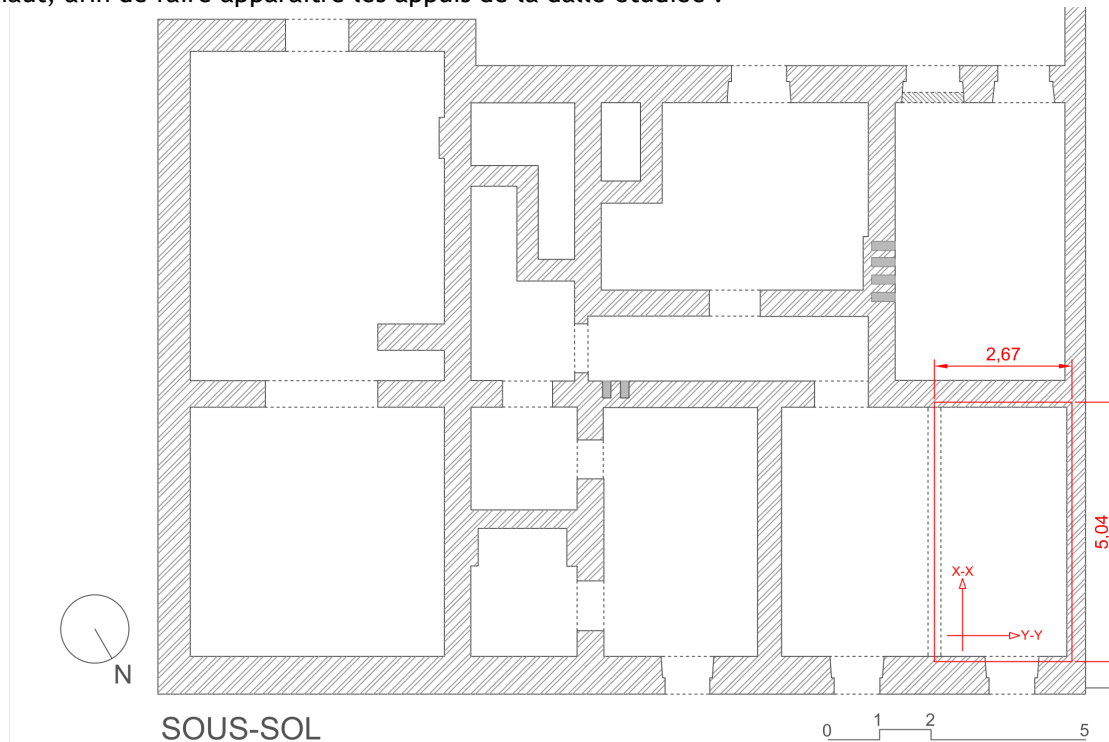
Plan du plancher étudié - ici plancher haut du sous-sol - local de l'angle nord-ouest.
